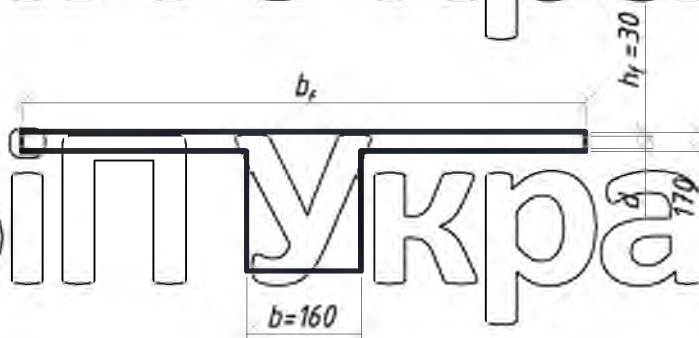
Приведений T-образний переріз з полочкою в стиснутій зоні
